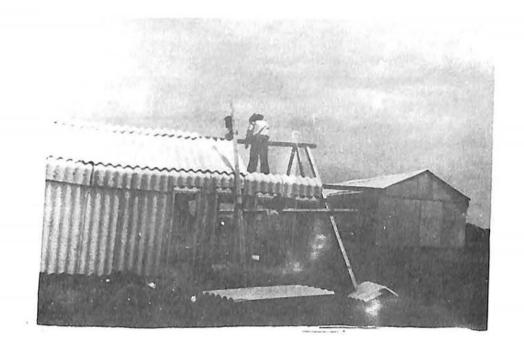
CONSTRUCCIÓN DE LA CASA DESTINADA A OFICINAS Y BODEGAS.
